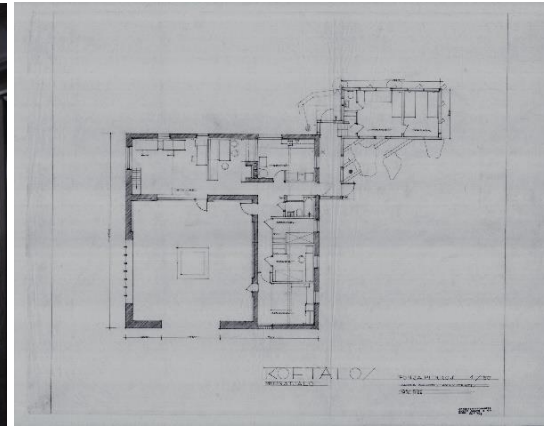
PLANTA BAJA EXPERIMENTAL HOUSE. FUENTE:
